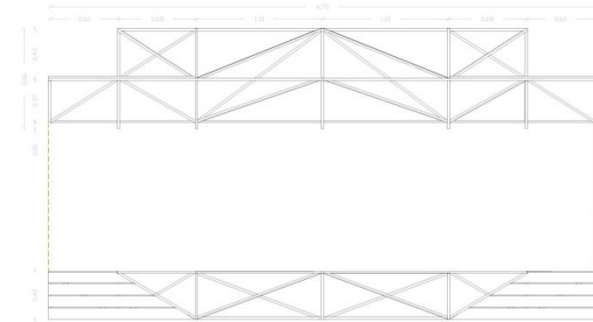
Elevación (arriba) y planta (abajo) de baranda
